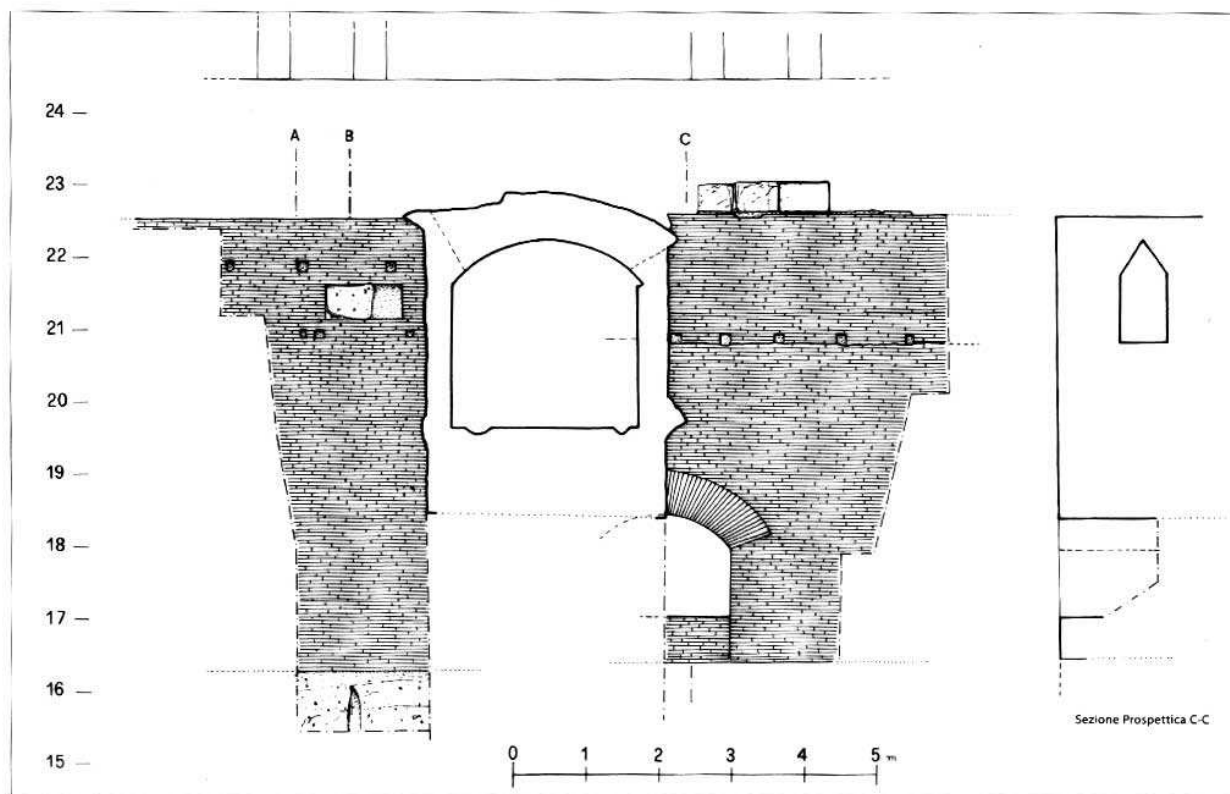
Versante meridionale del Colosseo, prospetto e sezione della galleria realizzata alla base della fondazione superiore, a quota inferiore rispetto al cosiddetto passaggio di Commodo; sulla sinistra le quote s. l. m., 1:100
